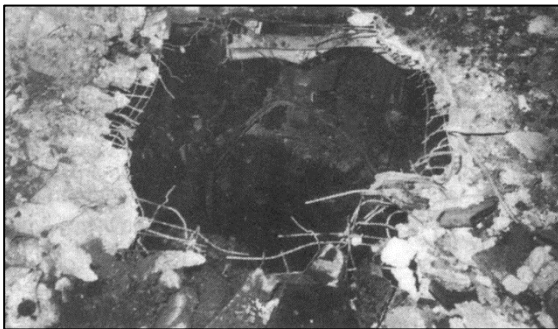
Emplacement ou se trouver un réacteur après une explosion thermique.
